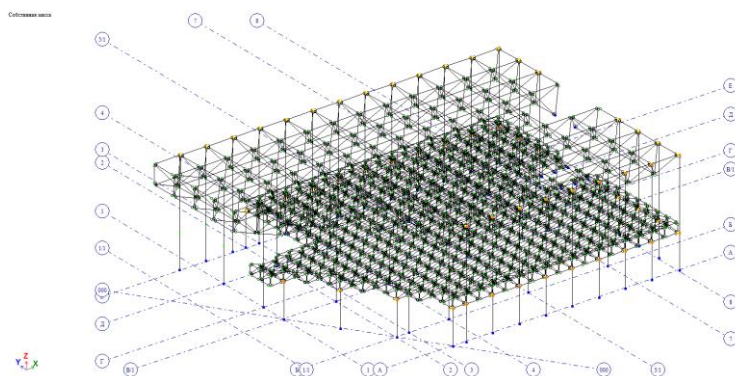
Общий вид расчетной схемы металлического каркаса здания
